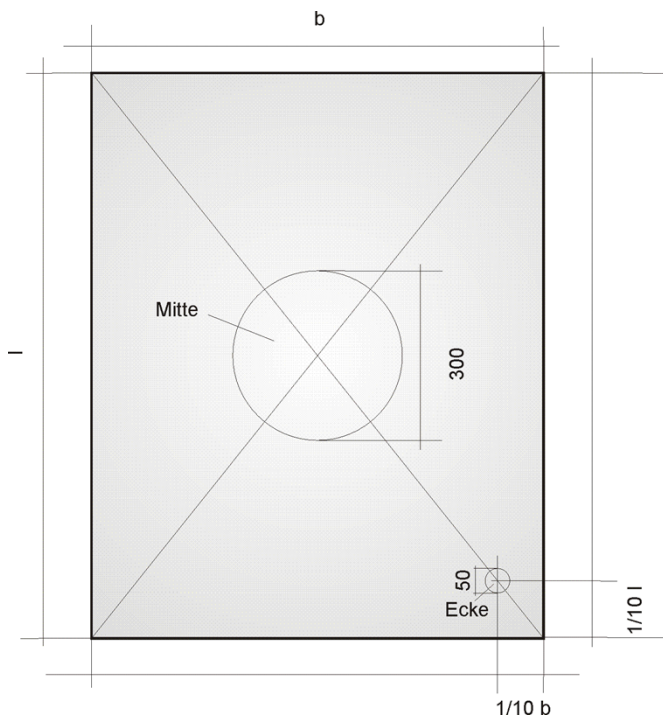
Beschussorte der Verglasung im Grundriss (Masse in Millimeter)
